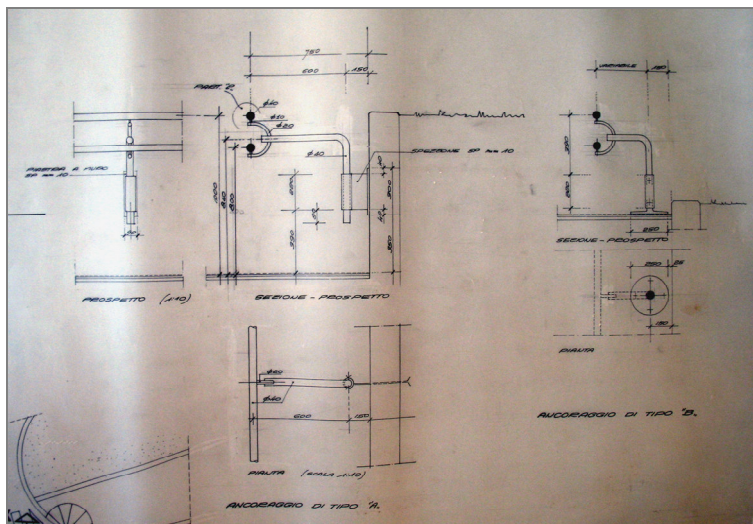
corrimano rampa ingresso principale – particolare (fonte CSAC – stralcio tav. 163, archivio n. 384-2)
